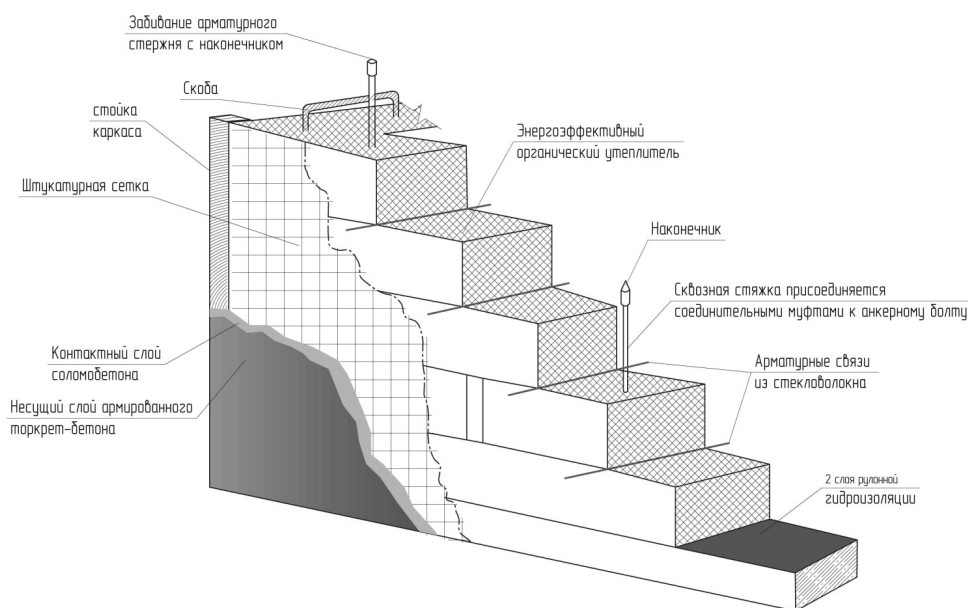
Формообразование многослойной конструкции “Сельская стена”
